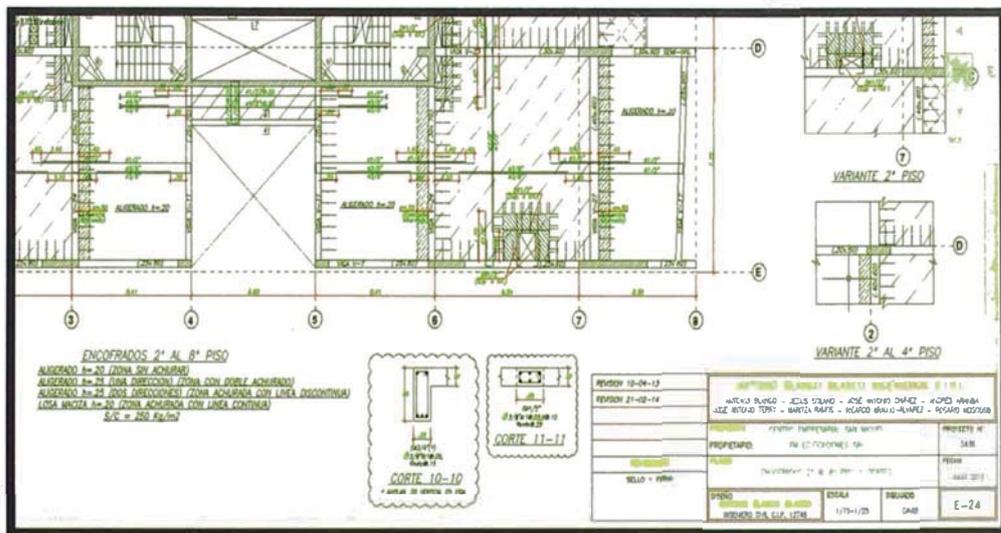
Planta de Encofrado de techos- Estructuras, lámina E-24- Espesores de losa de techo-e=25cm.
